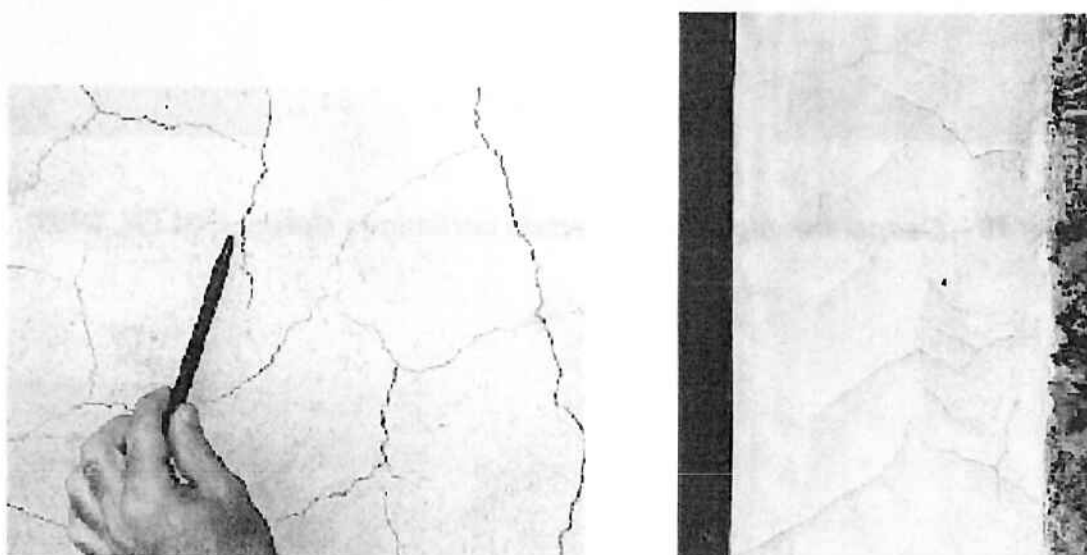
Trincas e Fissuras generalizadas.
